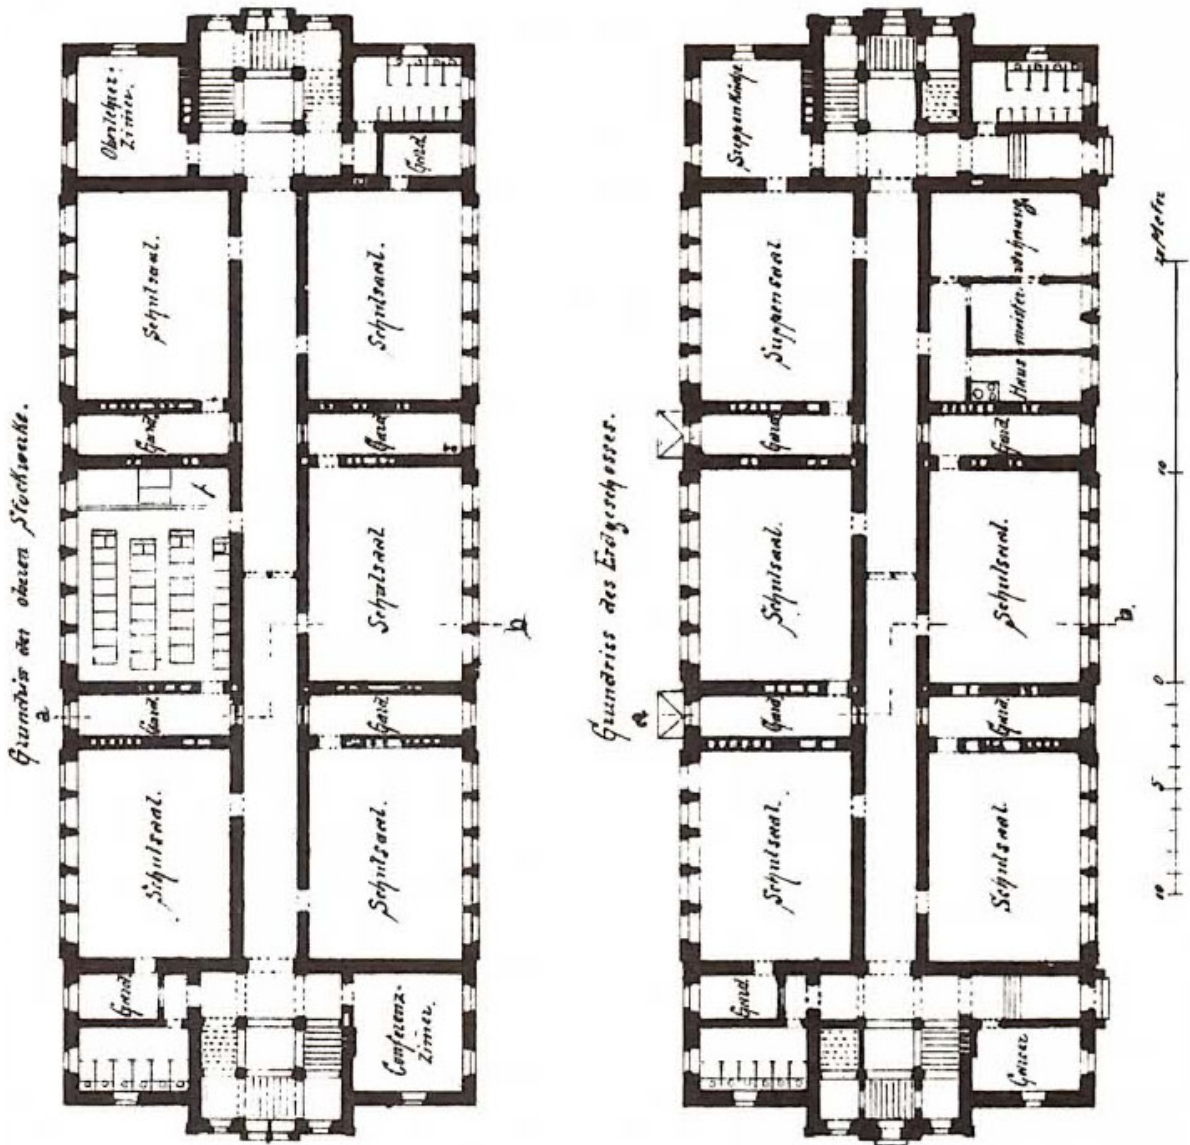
Grundriss-Vorbilder, Blatt 41 (Klassen 1884)
